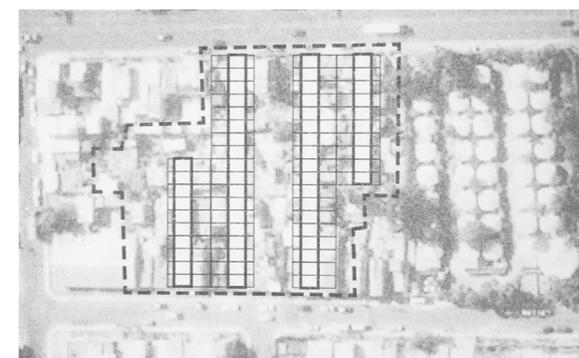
Sobreposição do loteamento em banda de dois pisos com o bairro existente.
